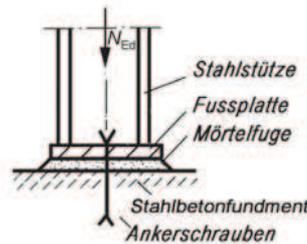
Stahlstütze auf Stahlbetonfundament
